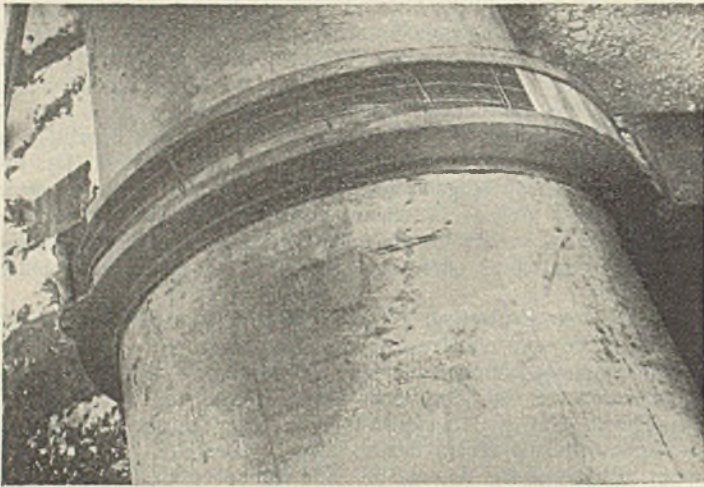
Überwurfmuße für Eisenbetonrohre nach dem Schleuderverfahren Vianini.
